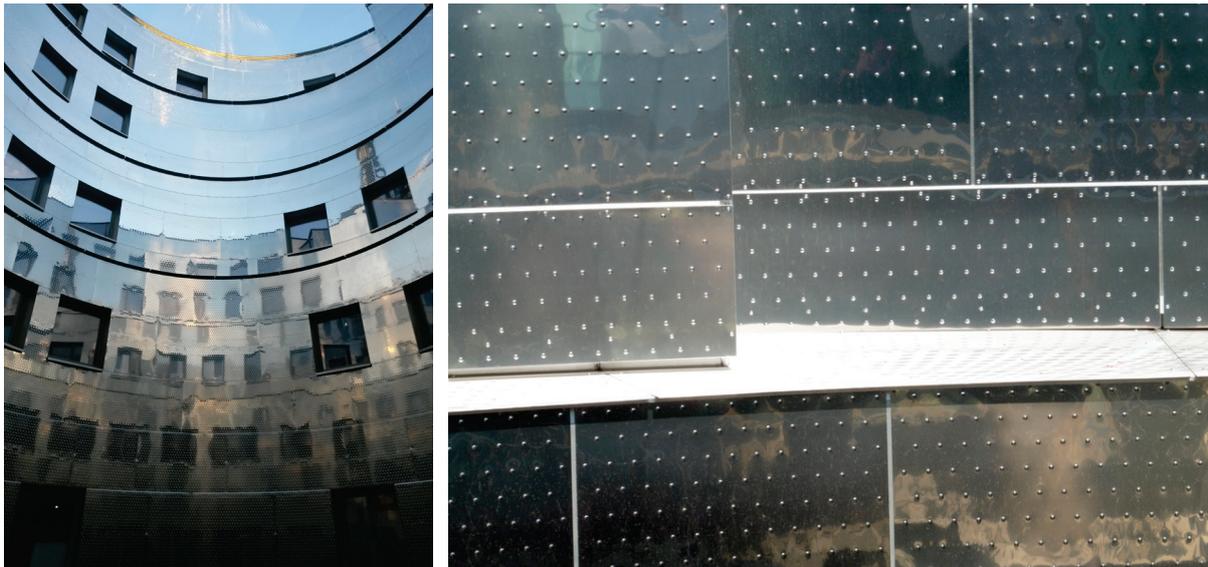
Projektbeispiel: Innenhof eines Wiener Hotels mit verspiegelten Oberflächen (links), Detailansicht Material mit Prägung um Entmaterialisierung zu minimieren (rechts)
